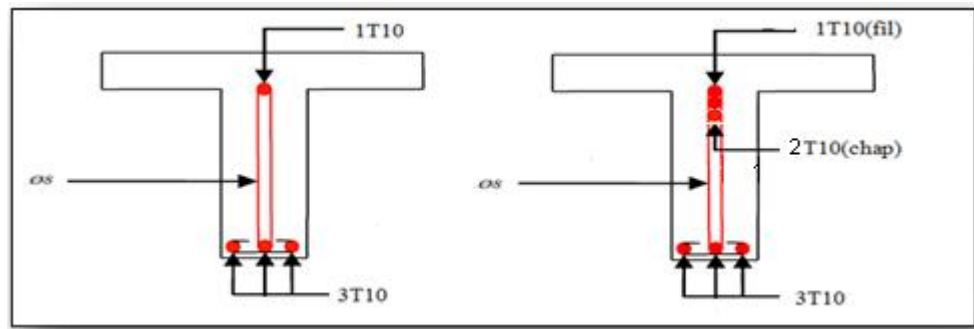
Schémas ferrailage des Poutrelles intermédiaires
